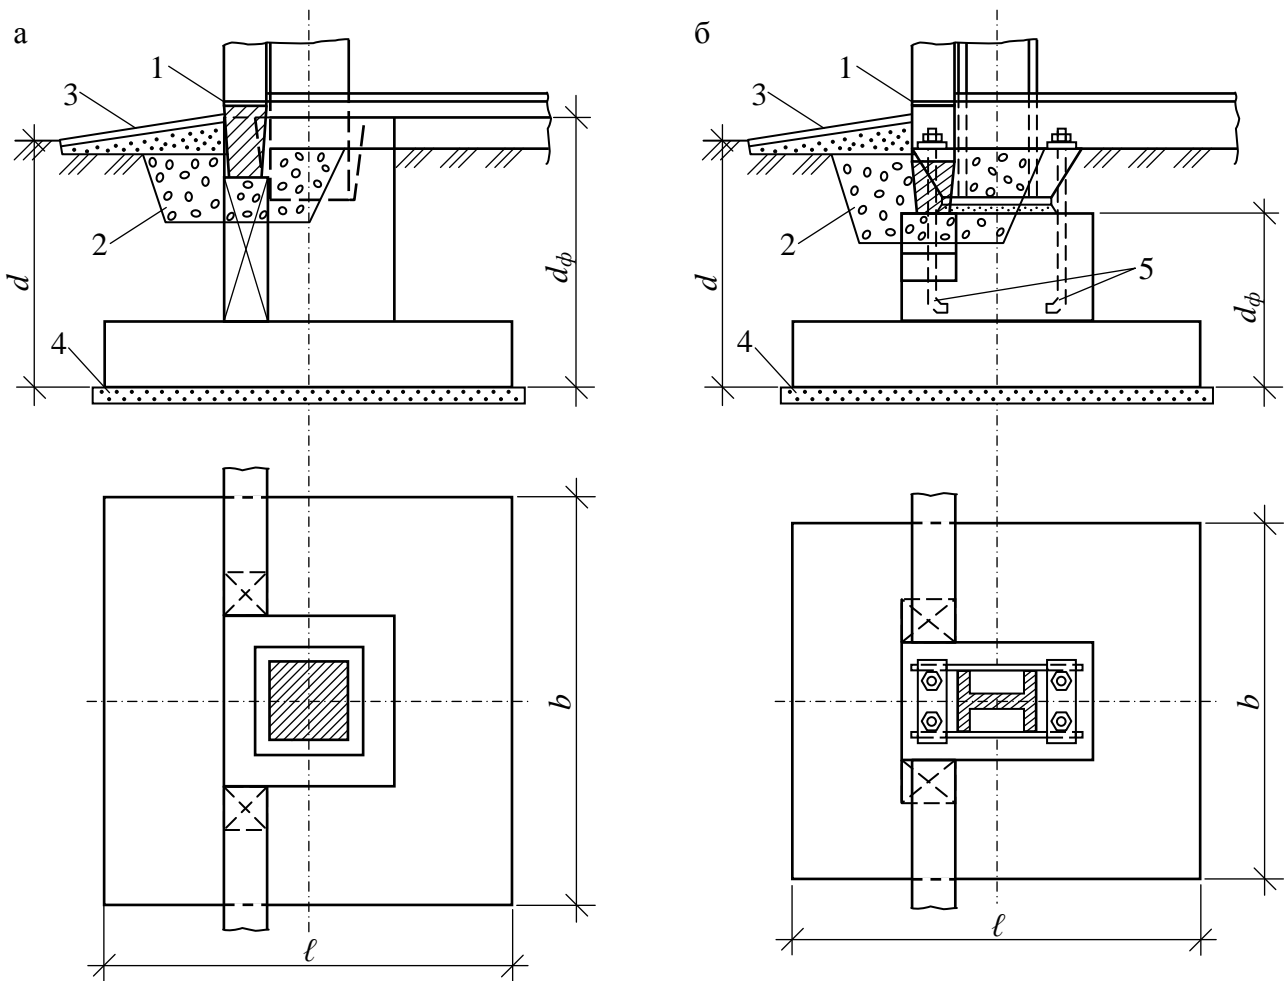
Монолітний залізобетонний фундамент під збірну залізобетонну колону (а) та під металеву колону (б):
